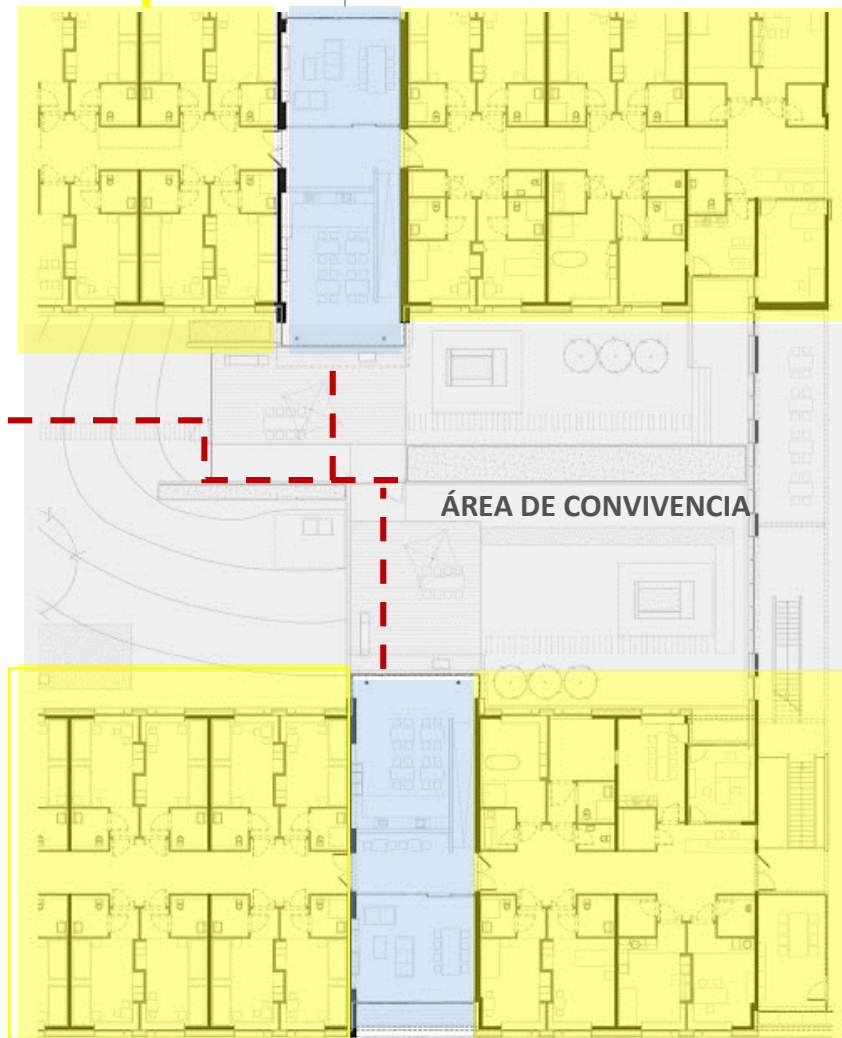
Planta baixa setorização dos ambientes e acessos 1 e 2 pavimento CENTRO PSIQUIATRICO FRIEDRICHSHAFEN
